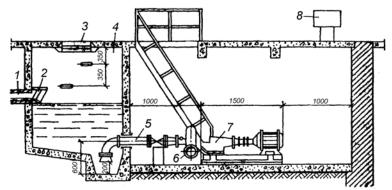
Насосная установка для перекачки сточных вод с приемным резервуаром: 1 – подающая труба; 2 – решетка; 3 – крышка; 4 – приемный резервуар; 5 – всасывающая труба; 6 – напорный трубопровод; 7 – насос; 8 – вентиляция.
